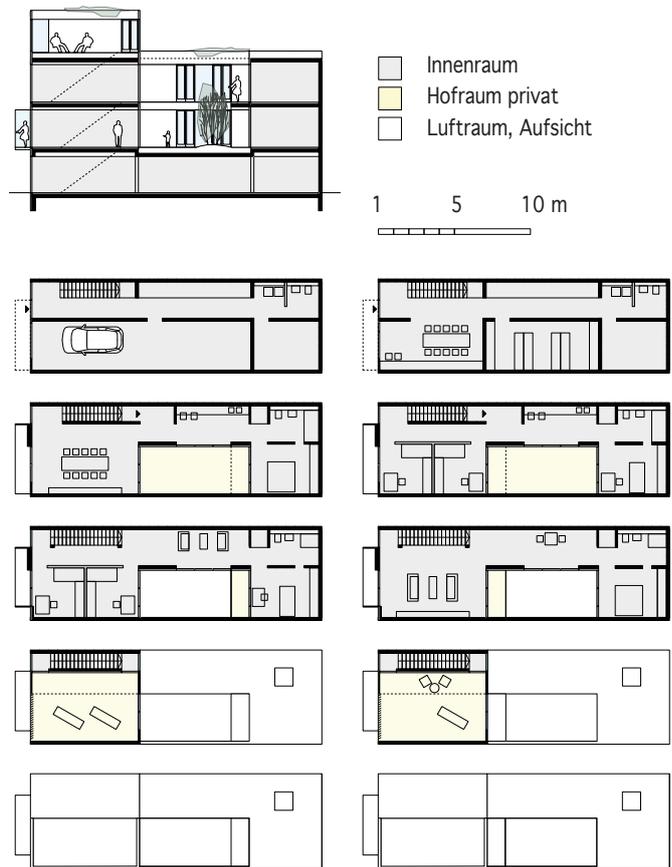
Typ 121-K1-3-1-2.8, Längsschnitt und Grundrisse in zwei Nutzungsvarianten, ggf. auch auf die jeweilige Orientierung reagierend. Grundstücksgröße $6,3 \times 19,2 \text{ m} = 121 \text{ m}^2$.
